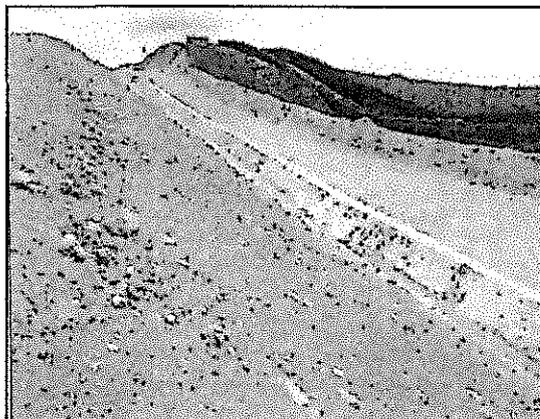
Canal de coronación Noreste del Depósito de Mina – Después de la Construcción
